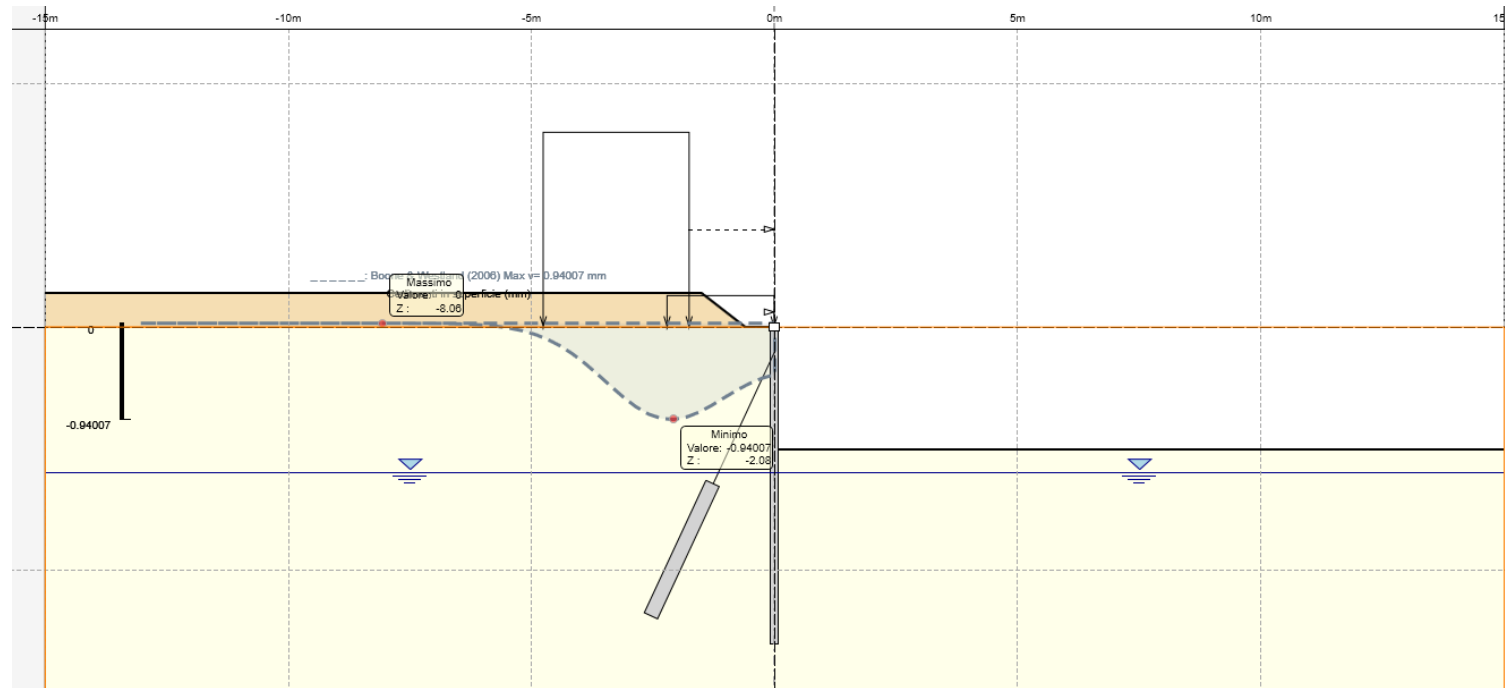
Stützwall TYP 3A, km 2+530: GZG,
